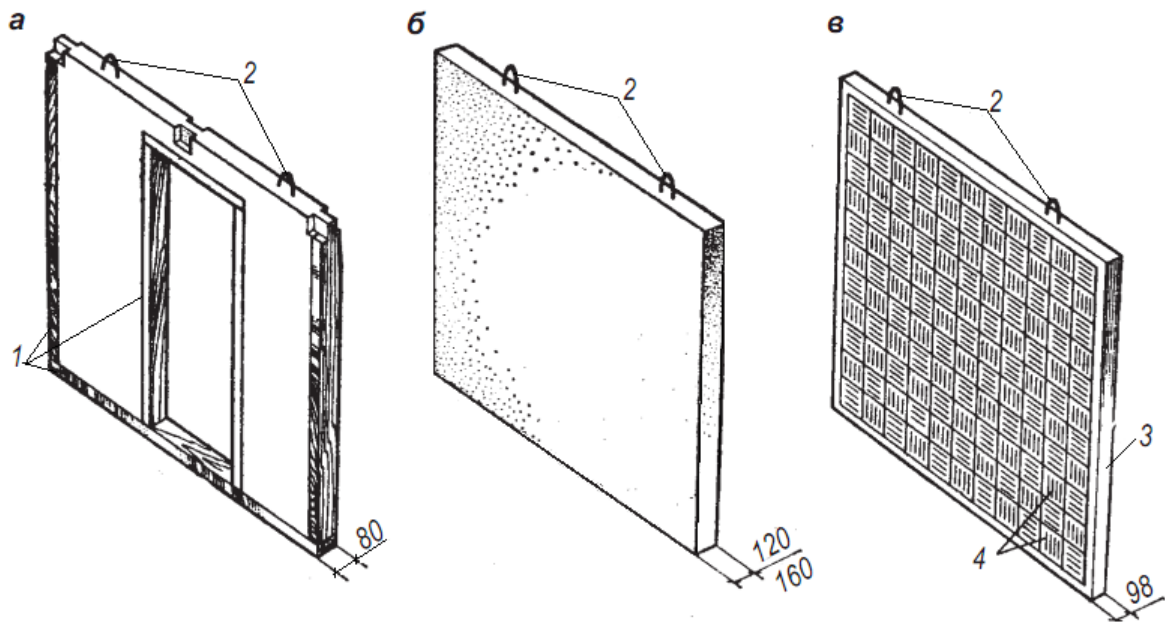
Великопанельні перегородки: а – гіпсобетонні; б – залізобетонні; в – склозалізобетонні; 1 – обв'язка з дерев'яних брусків; 2 – монтажні петлі; 3 – залізобетонна обв'язка; 4 – склоблоки
